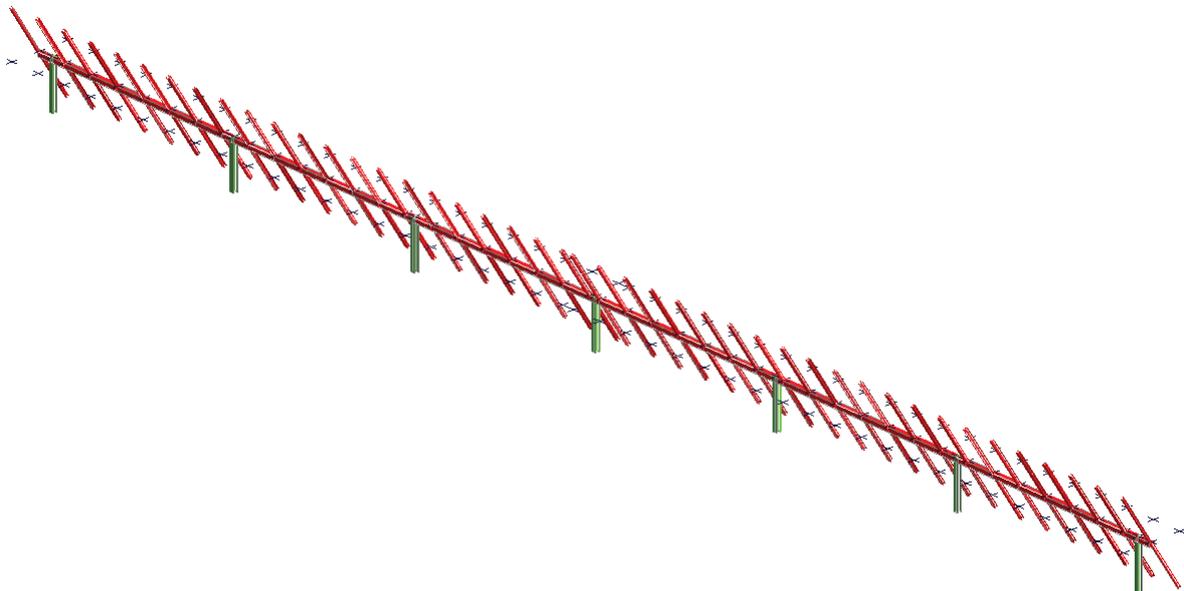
Rappresentazione tridimensionale della struttura (vista posteriore)
